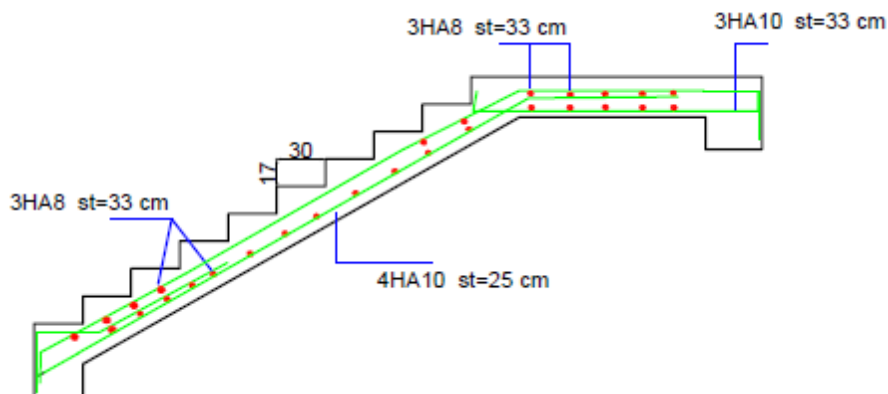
Schéma de ferrailage de l'escalier d'entrée
